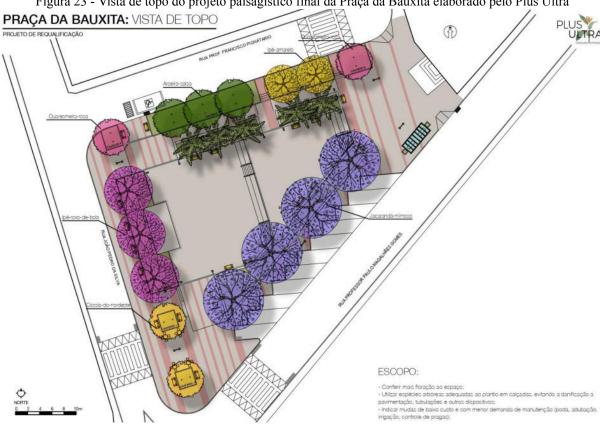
Vista de topo do projeto paisagístico final da Praça da Bauxita elaborado pelo Plus Ultra
